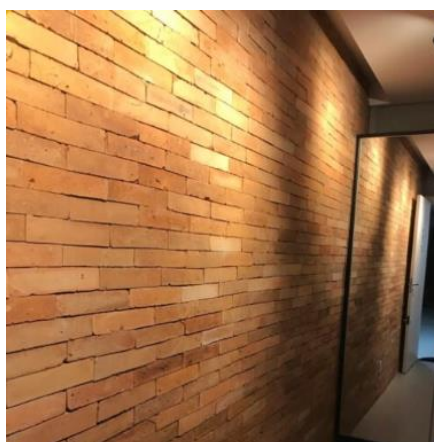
Plaquetas de tijolo. Fonte: Site da Plaquetas & Tijolos de Demolição<sup>49</sup> (2019).
